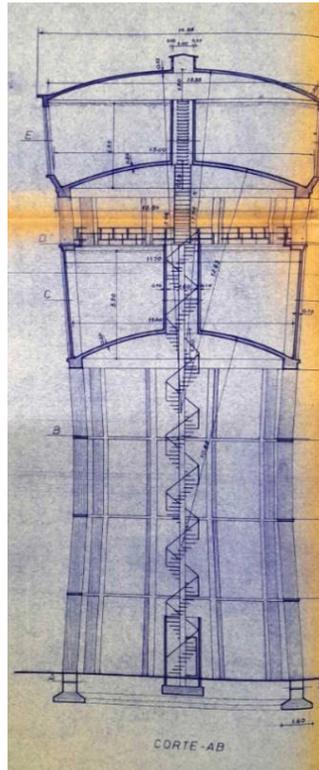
Corte AB do Depósito Duplo de Betão Armado para Água Doce e Salgada que a CUF construiu no Bairro Operário.
